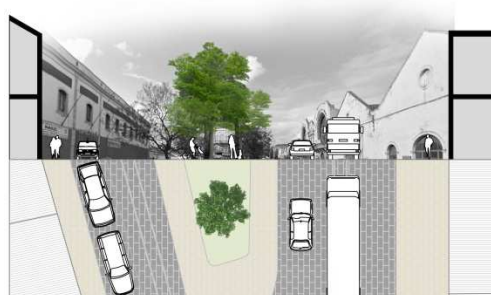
| Perfil de via sugerido para a Praça David Leandro da Silva.
